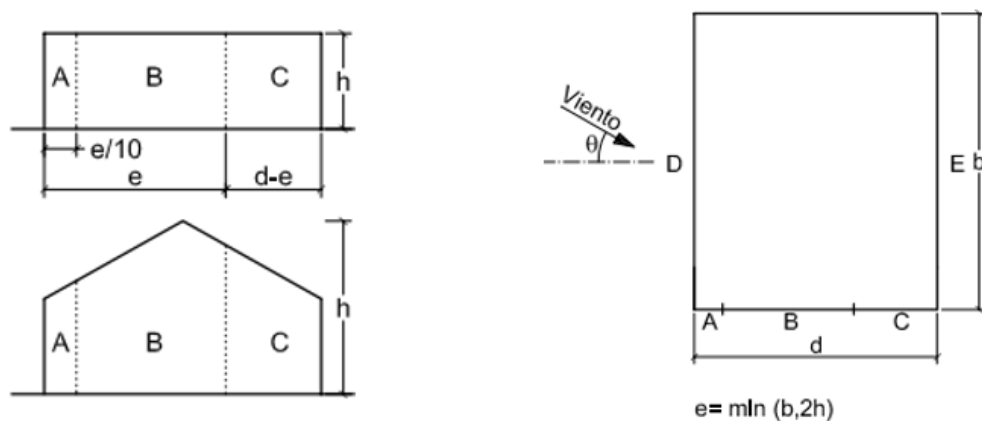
Áreas de influencia, en alzado y planta, de las fachadas verticales con viento a 0° [5]
